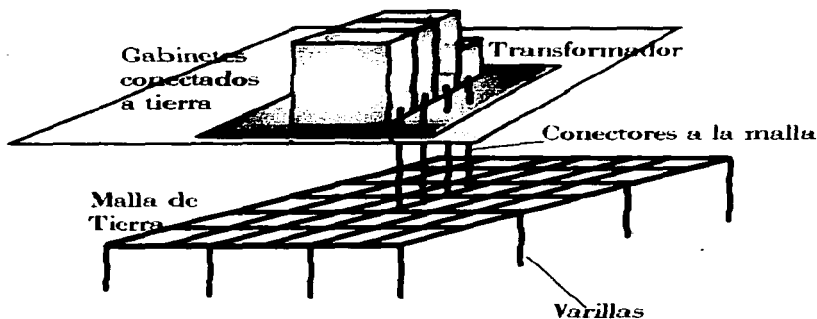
Disposición De La Red De Tierras Bajo La Subestación.
